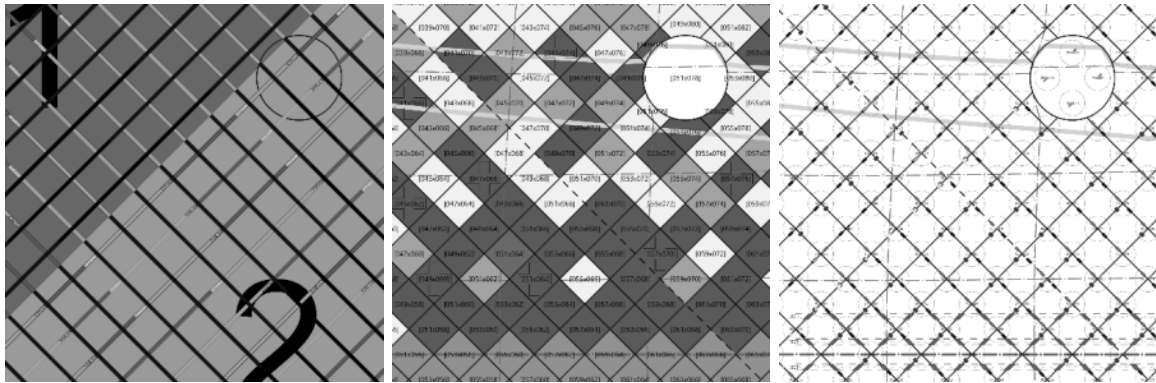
Detaillausschnitte des Flachplans mit (v.l.n.r.) Segmentierung und Montagerichtung, Elementtypen, Durchbrüche
